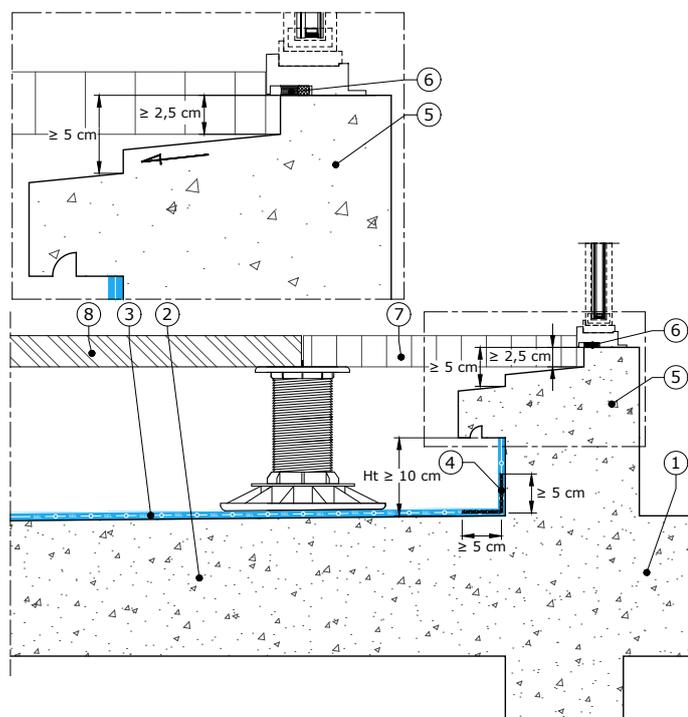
Exemple de seuil sans caniveau - Cas d'un S.E.L. avec protection par dalles sur plots
